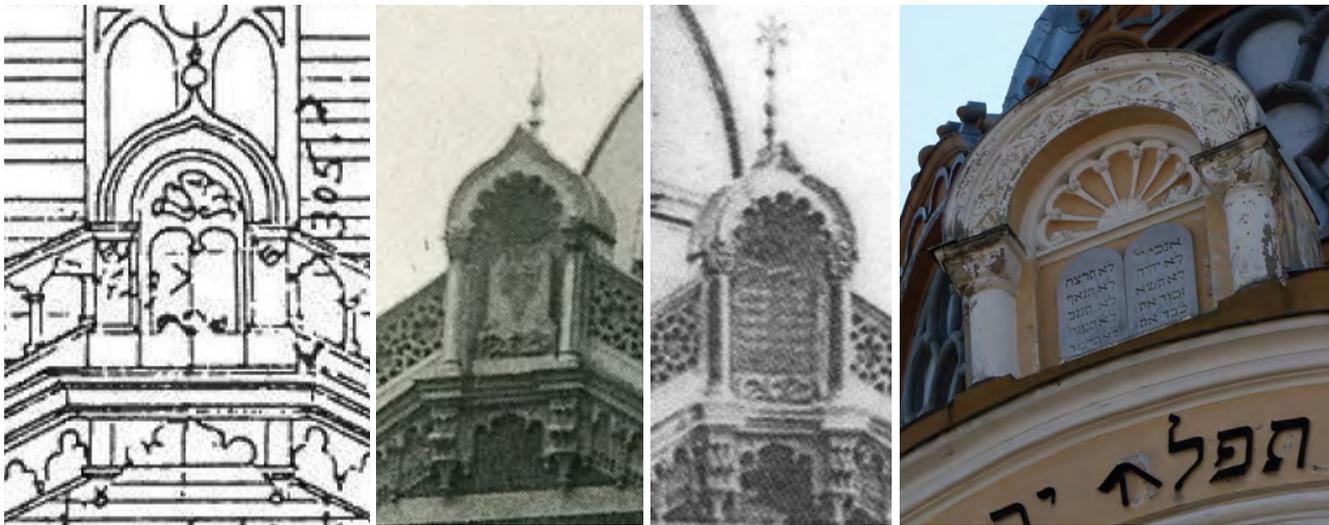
v.l.n.r.: Vergleich Gebotstafel, Planausschnitt, Ausschnitt der Fotografie der Rückfassade, Ausschnitt der Fotografie der Vorderfassade, Ausschnitt der Fotografie der Synagoge Târgu Mureș
